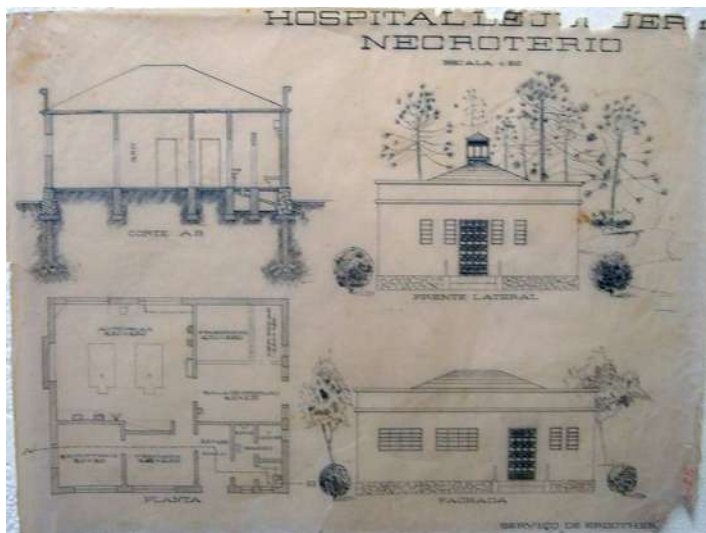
planta, corte esquemático e fachadas do necrotério (acervo SIOC).
